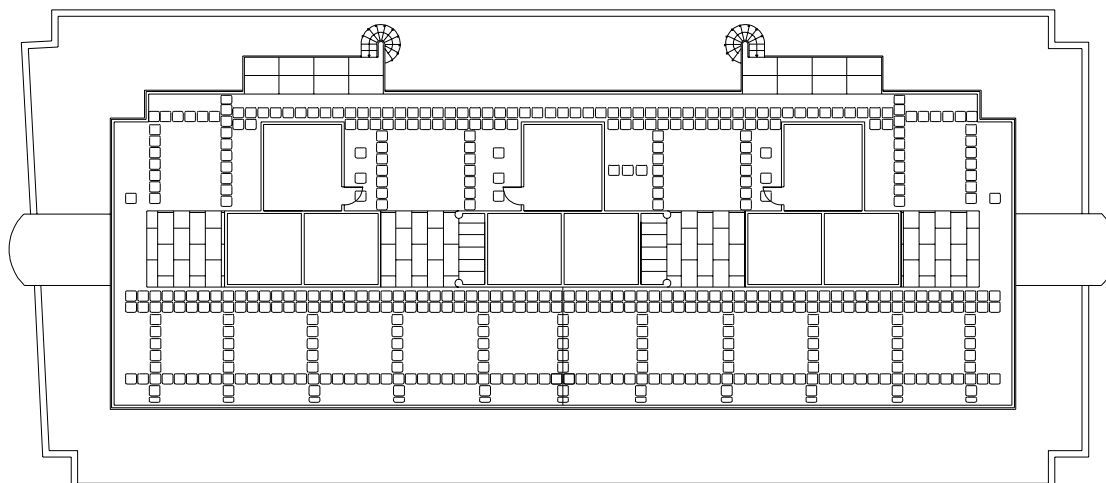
Planta do décimo-primeiro pavimento. Notar a continuidade do terraço-jardim e a cobertura dos vazios de iluminação.
